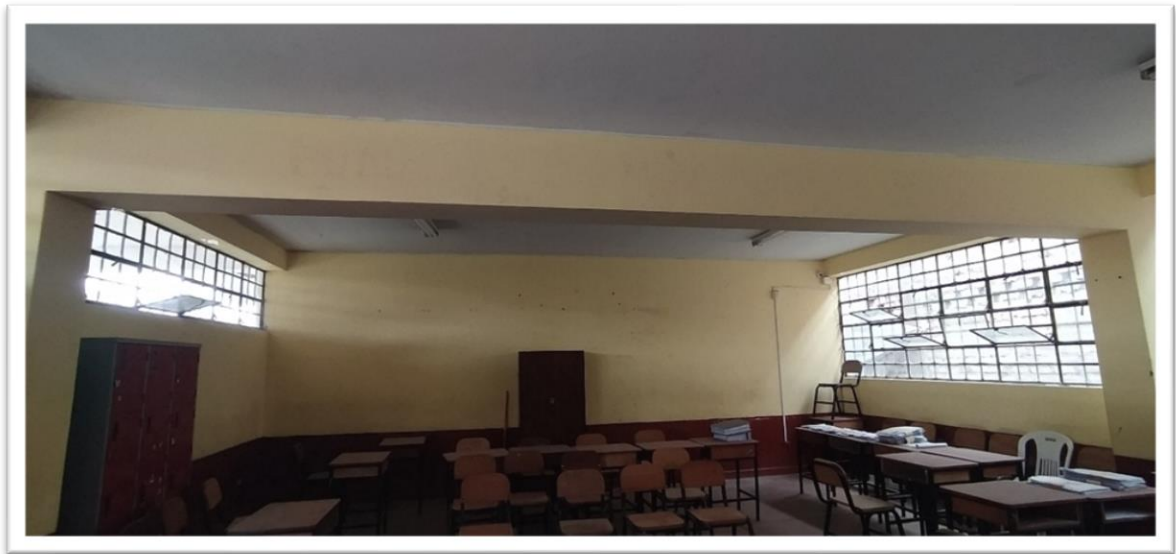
Losa Aligerada (Diafragma Rígido) en el primer piso del pabellón 11 – bloques A y B.
